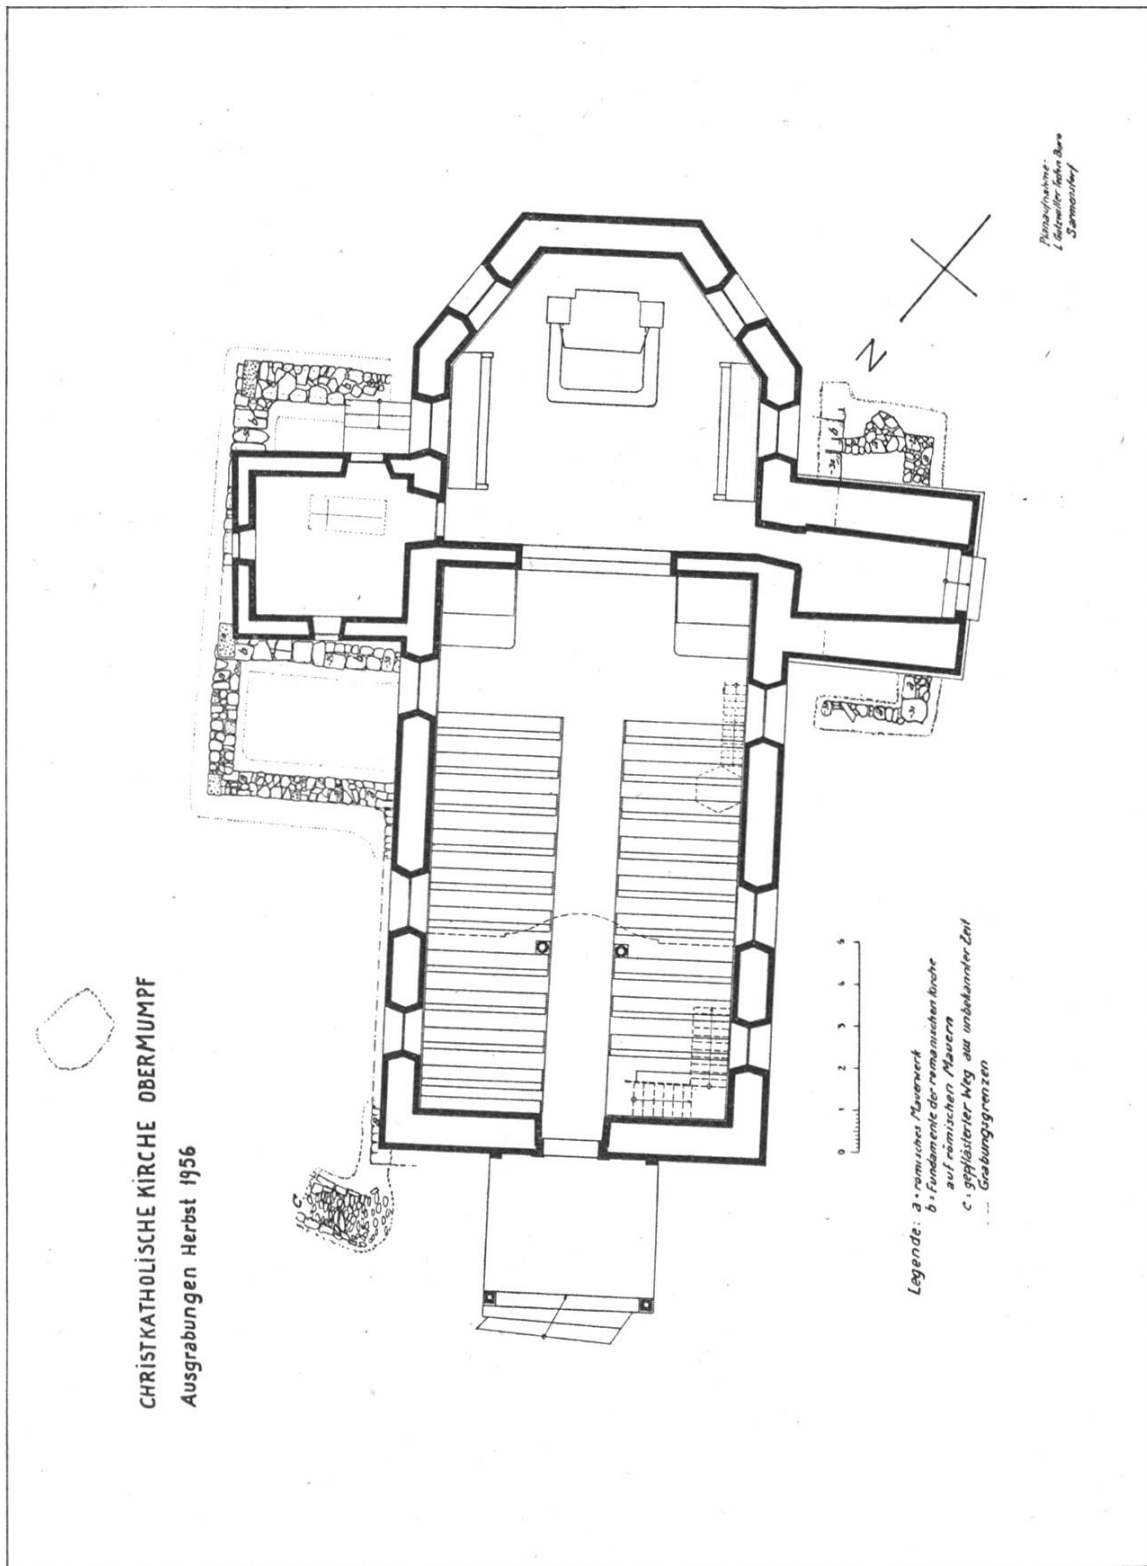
Grundriss der Kirche von 1738 und der Rest älterer Bauten.
